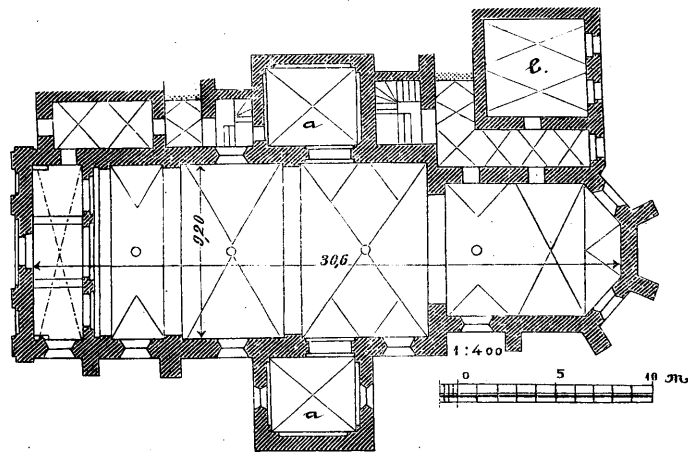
Neustadt. Grundriss der Klosterkirche.
